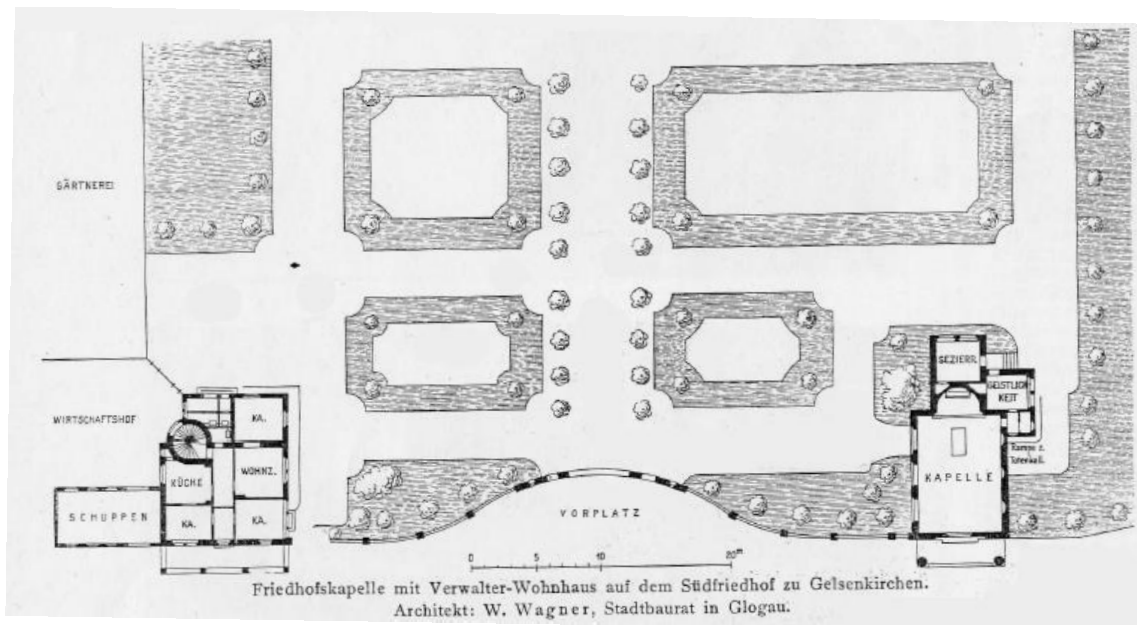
Lageplan und Grundrisse des Verwalterhauses und der ehem. Kapelle am Südfriedhof
